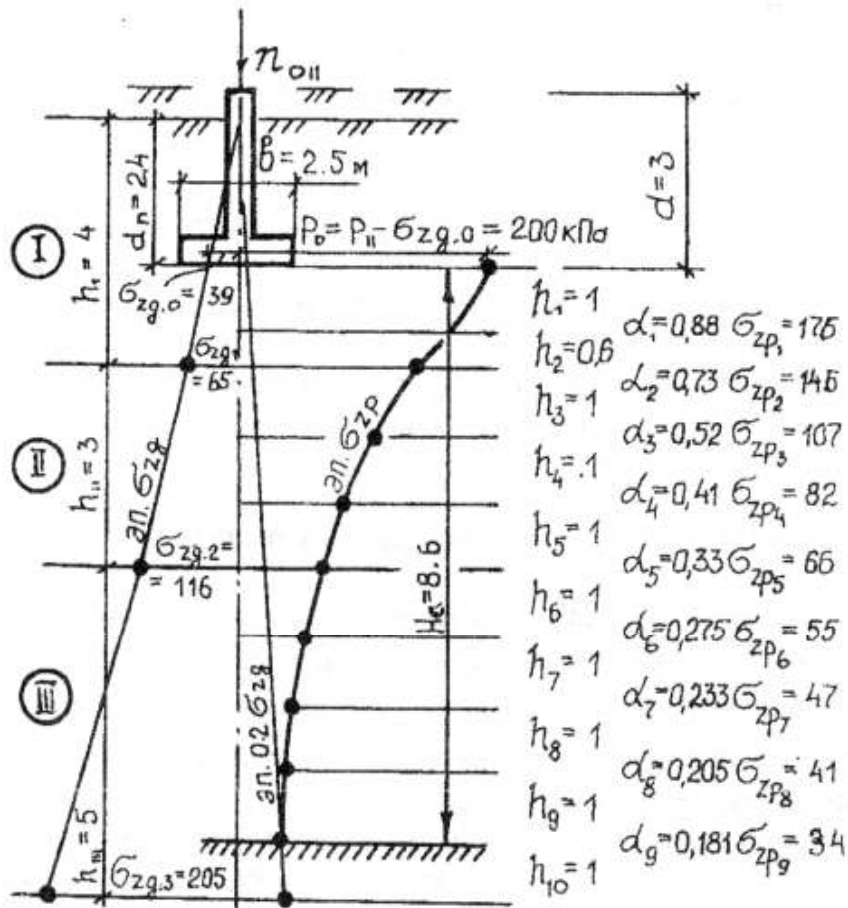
Расчетная схема для определения осадки фундамента по методу послойного суммирования
